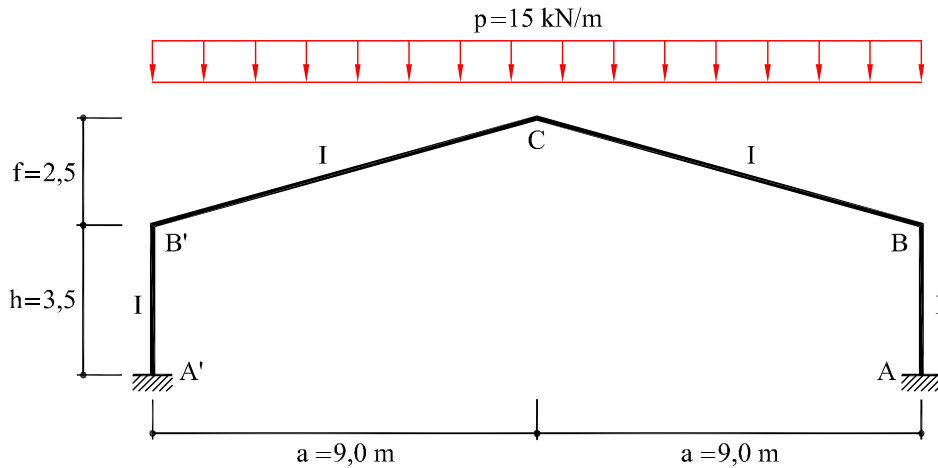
Pórtico del Ejemplo 7.6.2.4
